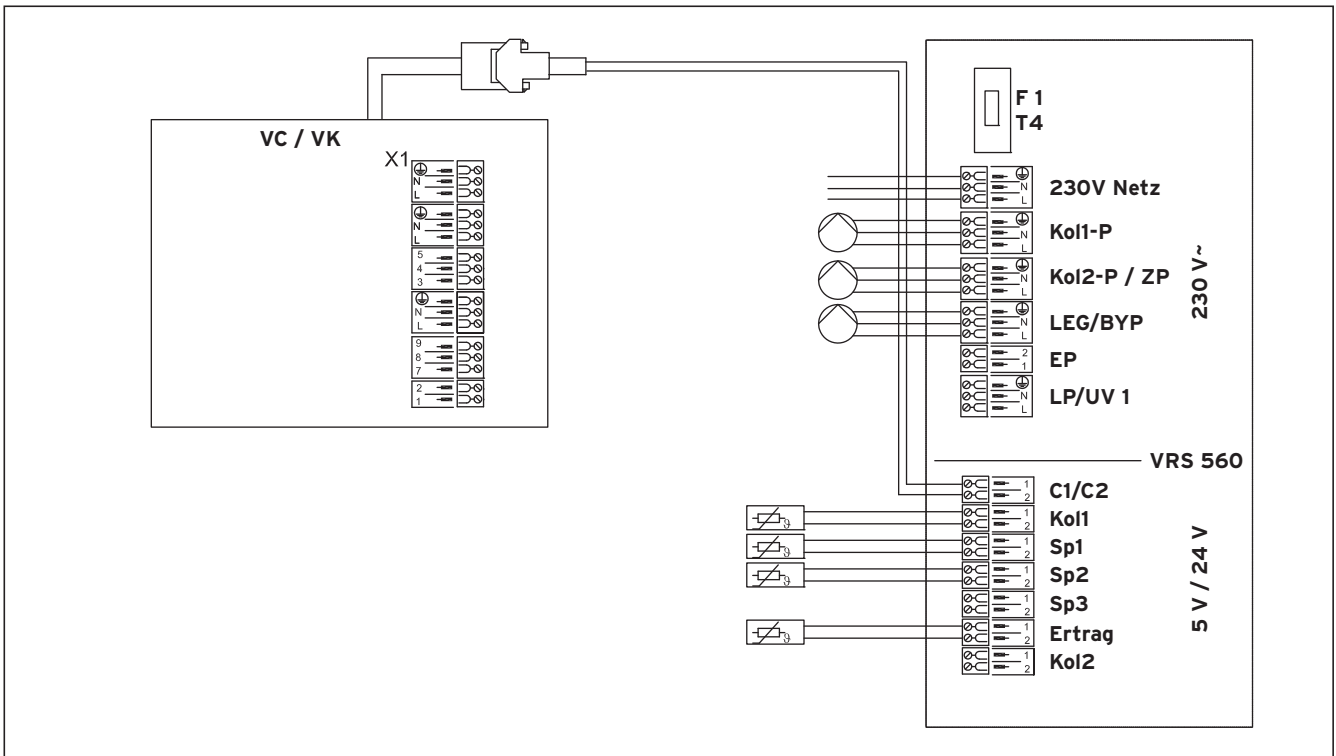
Plan de raccordement pour schéma hydraulique 1
